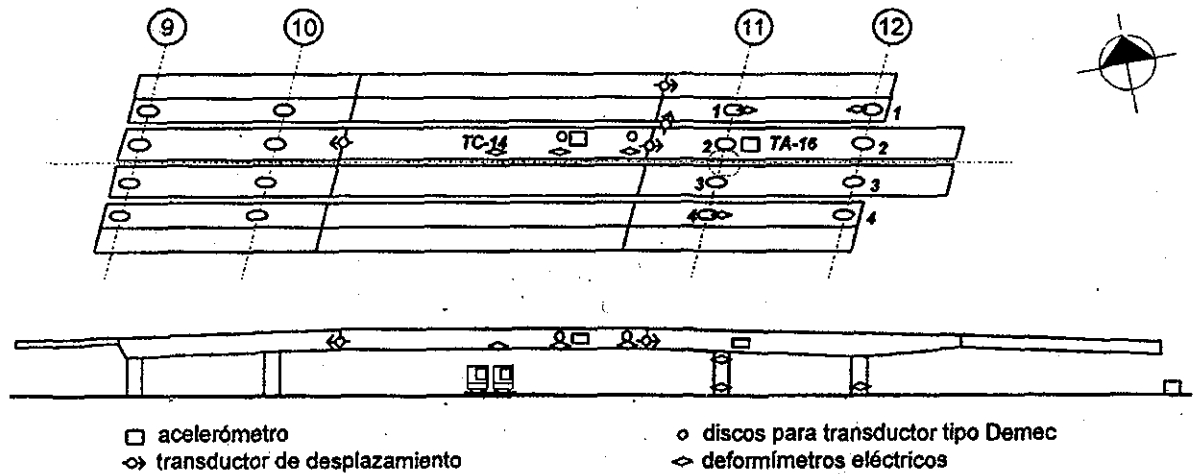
Planta del claro central y perfil de la superestructura del puente Impulsora e instrumentación instalada (Aguilar y Alcocer, 1997)
